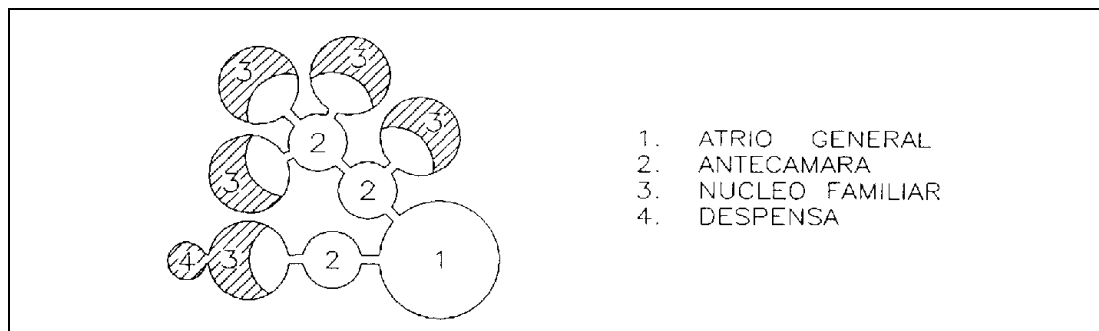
Planta esquemática de una agrupación de iglúes
